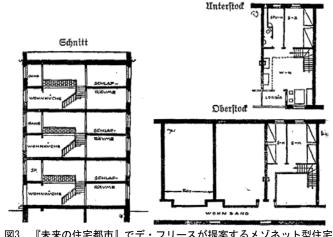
『未来の住宅都市』でデ・フリースが提案するメゾネット型住宅 断面図(左)、下階平面図(右上)、上階平面図(右下)
